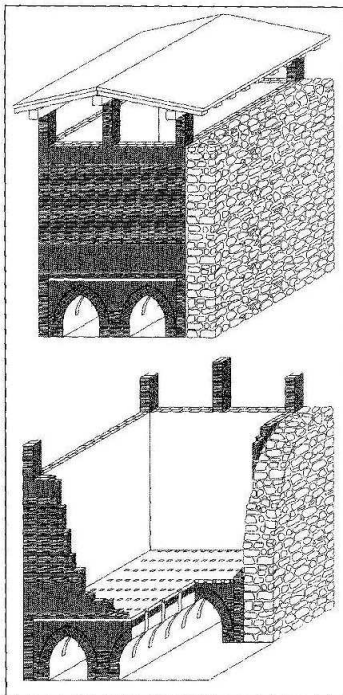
Tejera de Uriberrri Berri (Usurbil) Reconstrucción y corte transversal. Planimetría de Alex Ibáñez Etxebarria. Fuente: maestros tejeros en Guipuzcoa en edad moderna. Moraza Barea alfredo. p. 4. <https://idusus.es>
